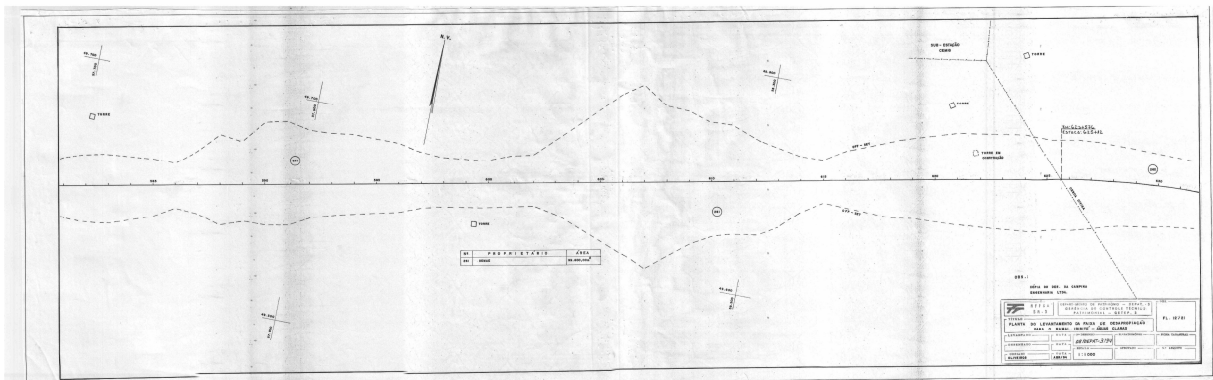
Planta RFFSA 08/DEPAT-3/94 – folha 12/21
